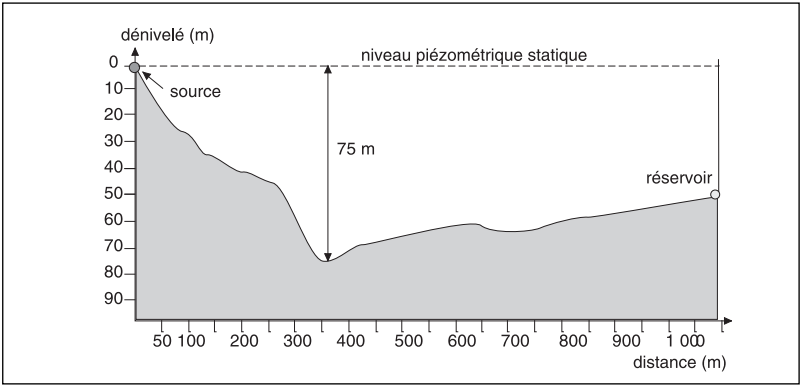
Profil statique et classe de pression des tuyaux.
